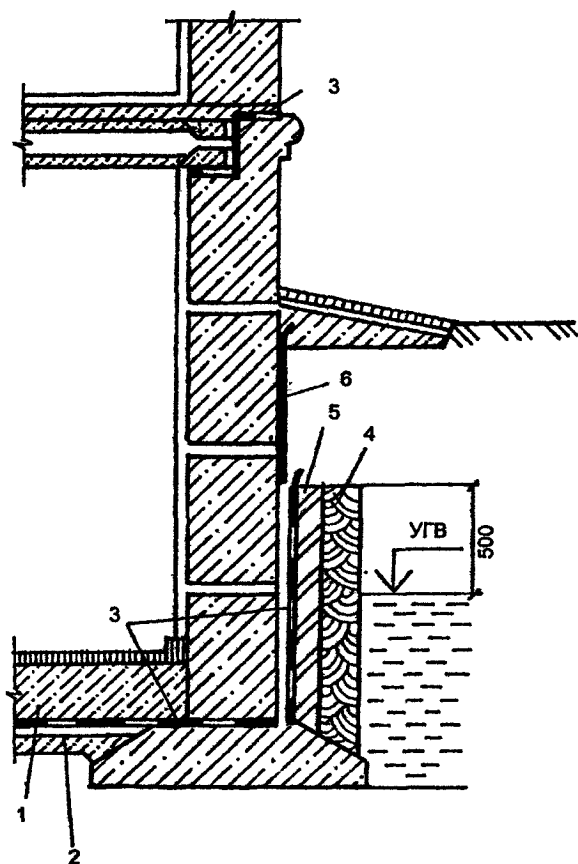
Гидроизоляция ленточного фундамента в здании с подвалом:
